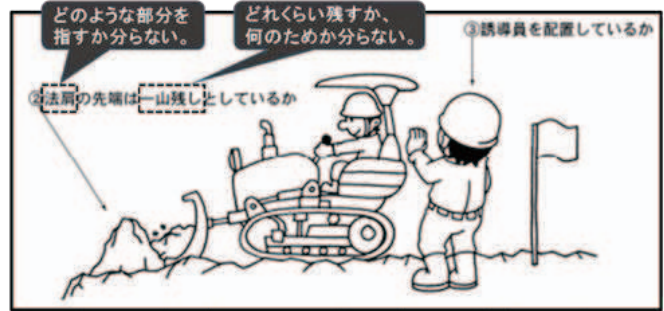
『建設機械施工安全マニュアル』P32ブルドーザ掘削での理解困難点か、といった点についての解説と説明を施していくことが求められていることがわかった。
